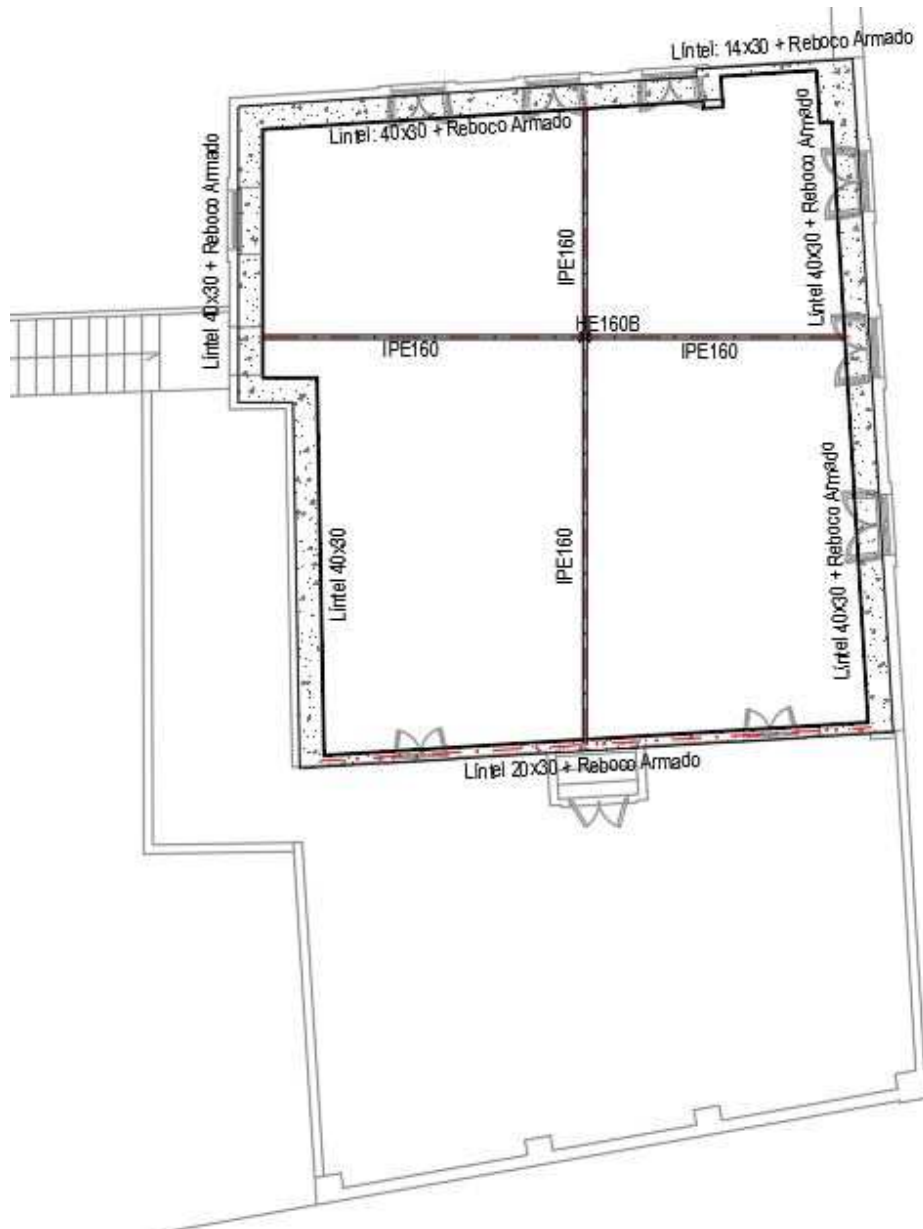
Planta do Sótão com as soluções de reabilitação e reforço.
